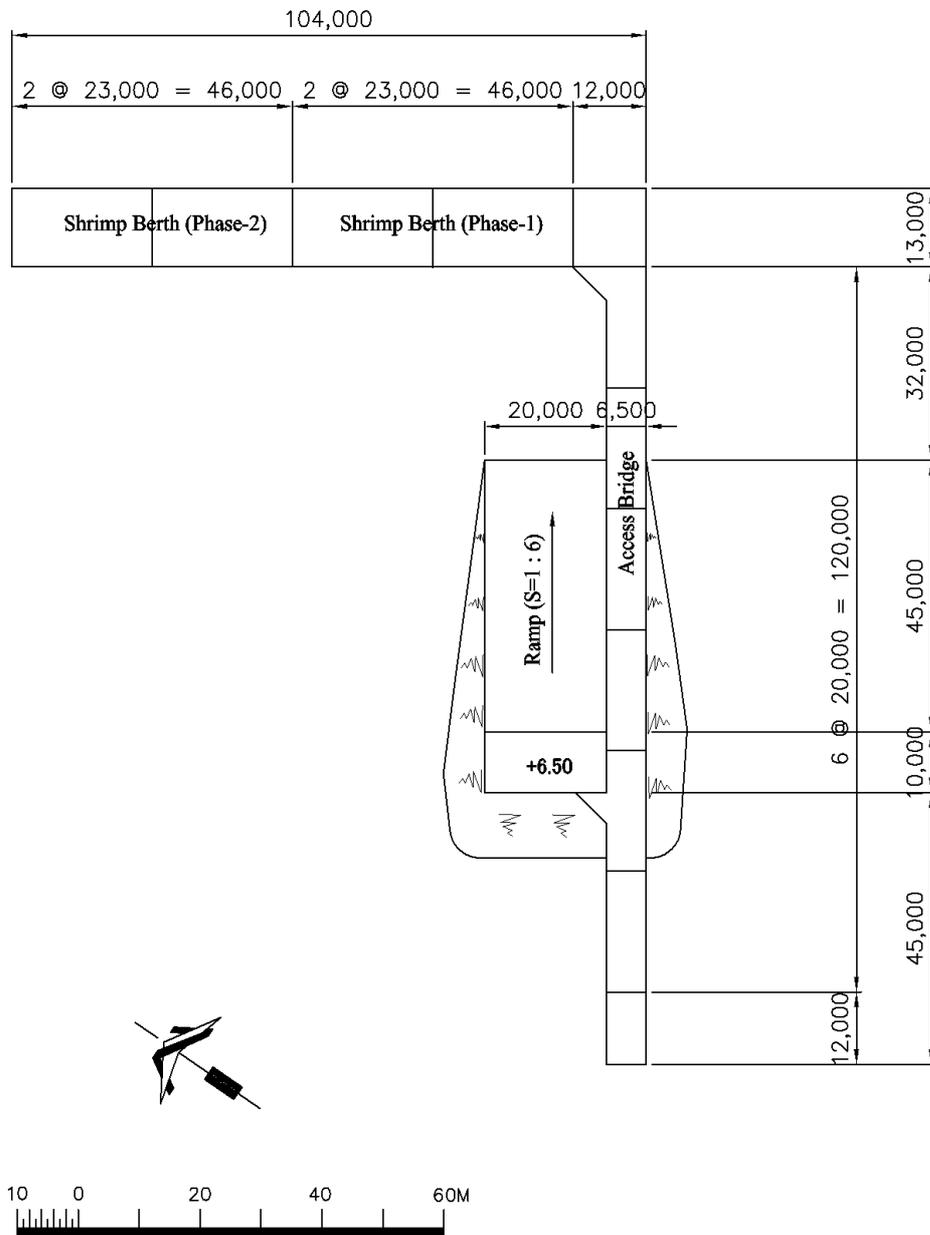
Disposición General del Plan de Instalaciones Marinas
